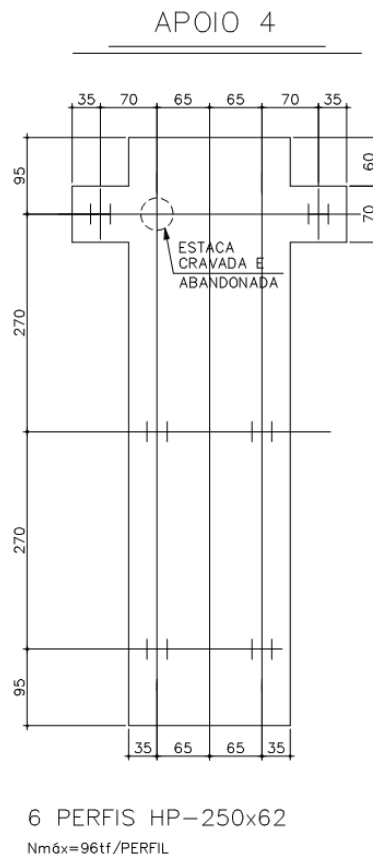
Reforço da fundação do apoio 4. (Alça de acesso ao Carrefour).
